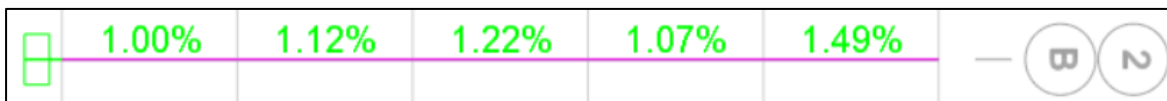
Cuantía requerida columna B2 - Sistema prefabricado. Fuente: Propia.
